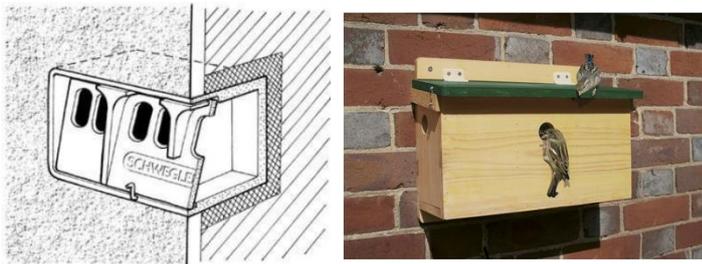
Nichoir encastré dans un mur (image de gauche) ou fixé à un mur (photo de droite)
